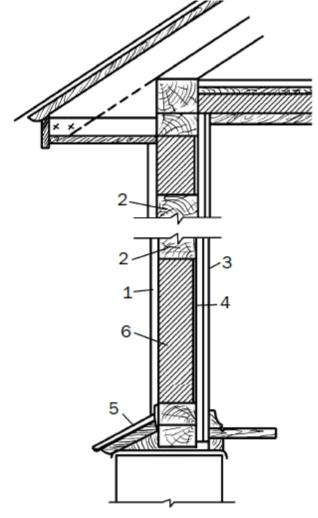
Конструкция каркасной стены в разрезе: 1 — наружная обшивка; 2 — брусья каркаса; 3 — внутренняя обшивка; 4 — слой пароизоляции; 5 — отлив; 6 — утеплитель
